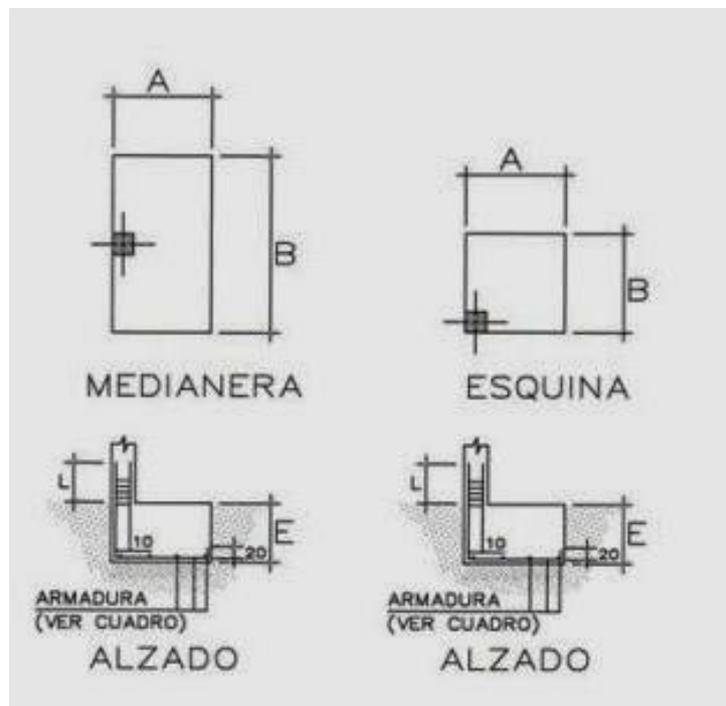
Detalle de zapatas esquinera y medianera en planta y frontal.
